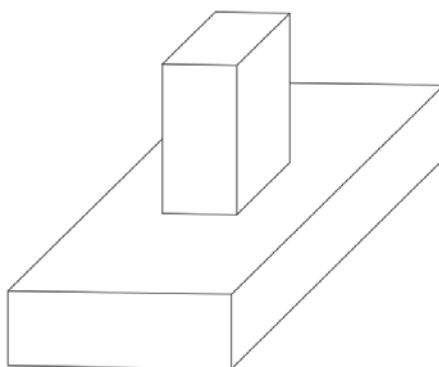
Diseño de la estructura de la zapata y el enano. Fuente: Elaboración propia.
